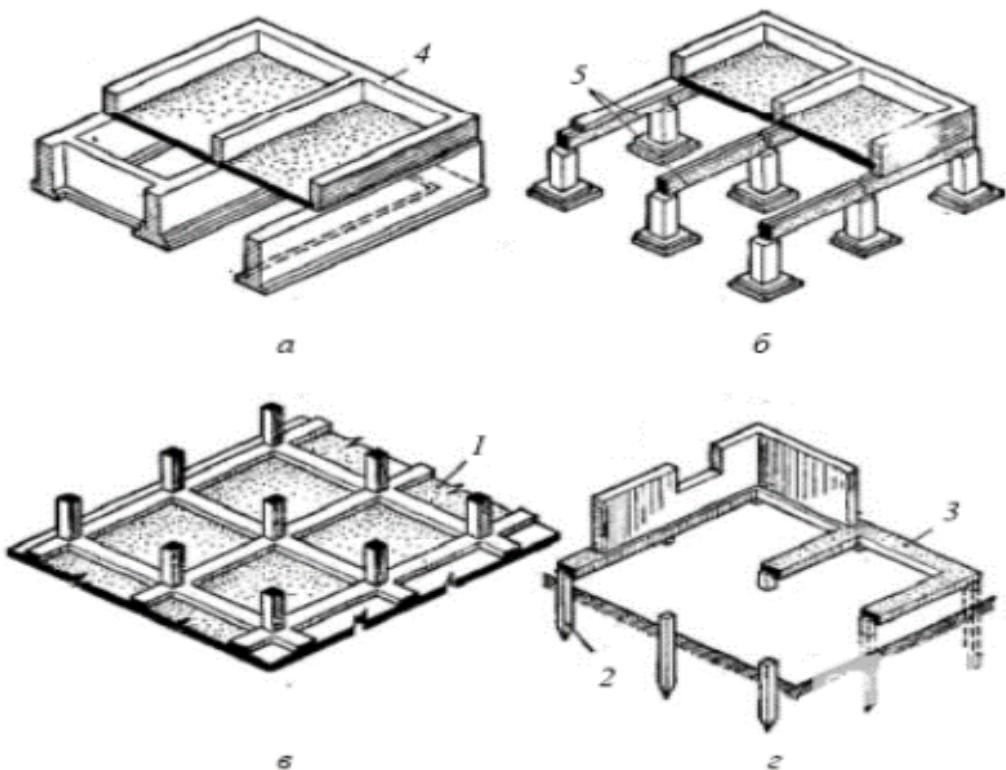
Конструктивные схемы фундаментов: а — ленточный; б — столбчатый; в — сплошной; г — свайный: 1 — монолитная железобетонная плита; 2 — сваи; 3 - ростверк; 4 — стена; 5 — фундаментные балки
